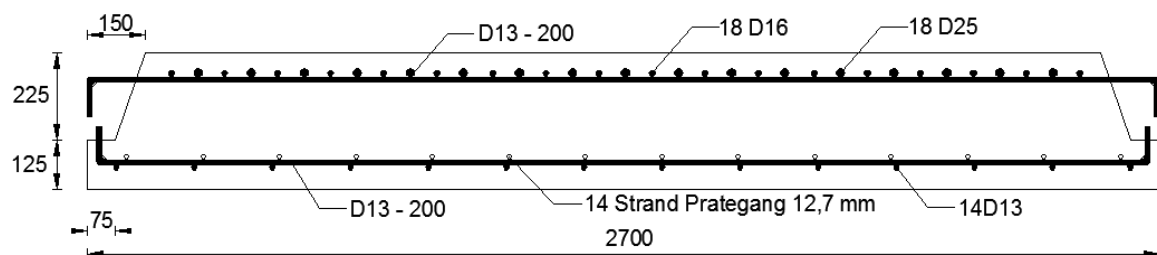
Detail penulangan elemen pelat pracetak prategang lapisan bawah
